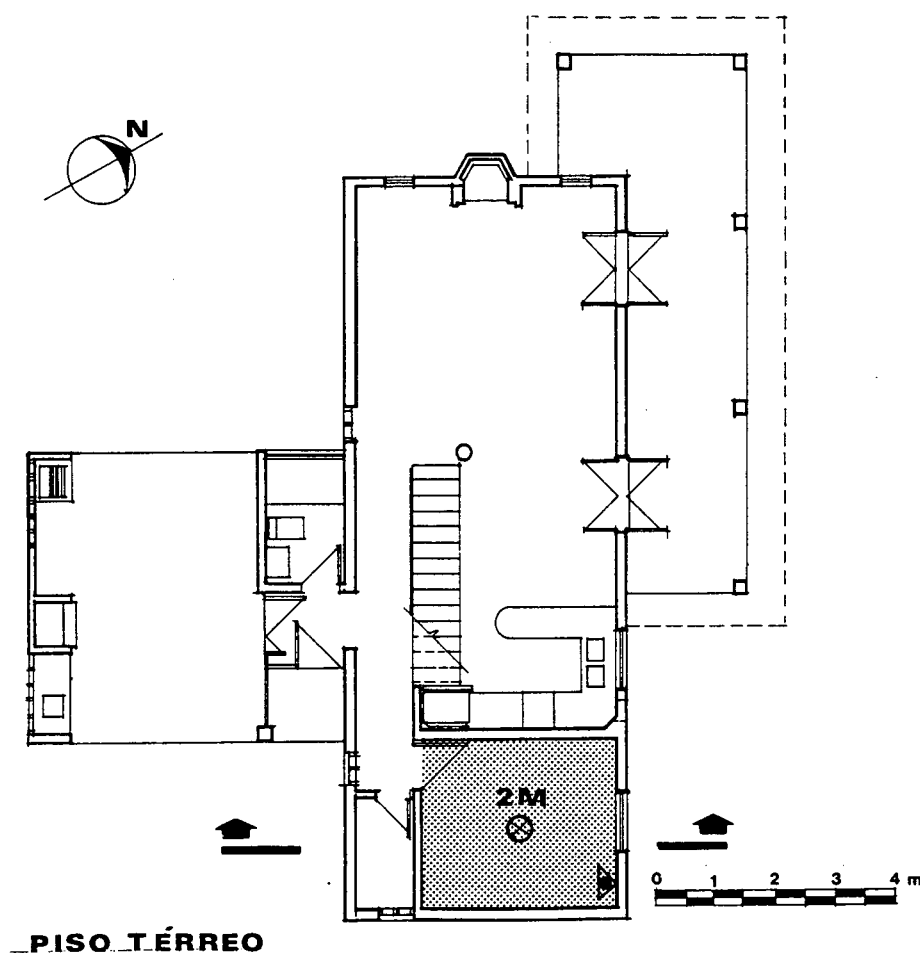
Planta do pavimento térreo da casa n°2 (Campeche)
